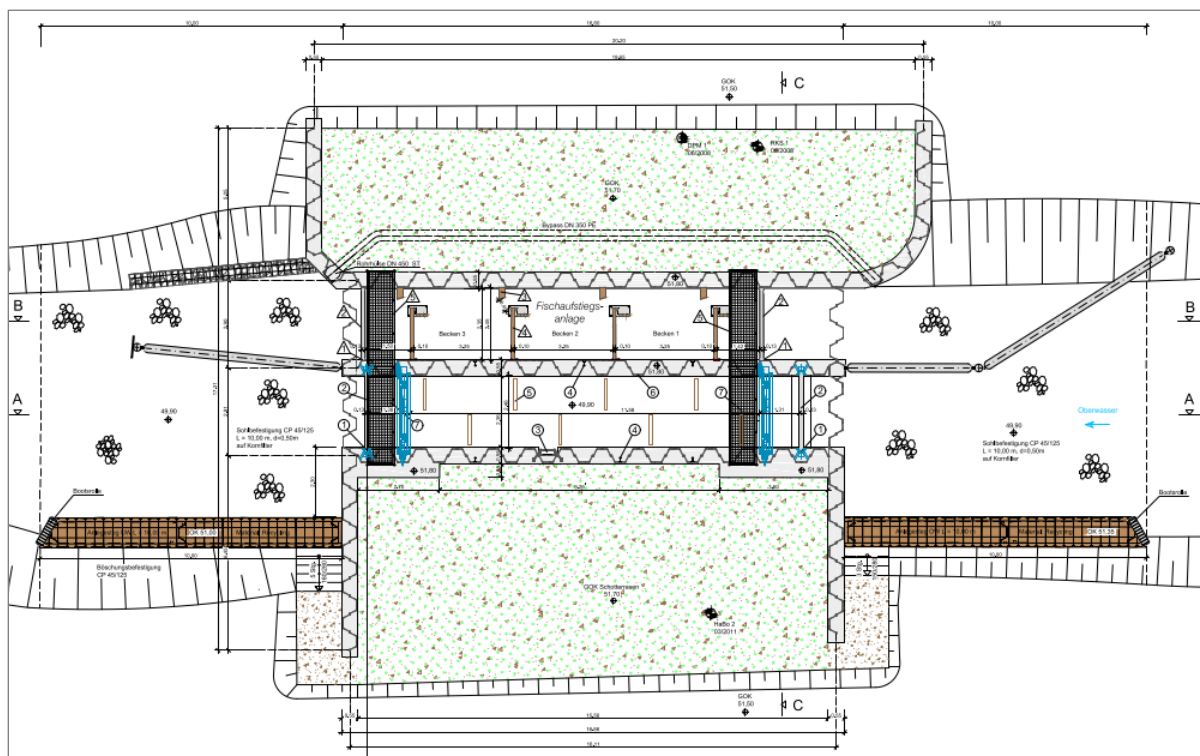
Lageplan Wehrstandort mit Schleuse und Fischaufstiegsanlage (hier Wehr 42) /P3/
